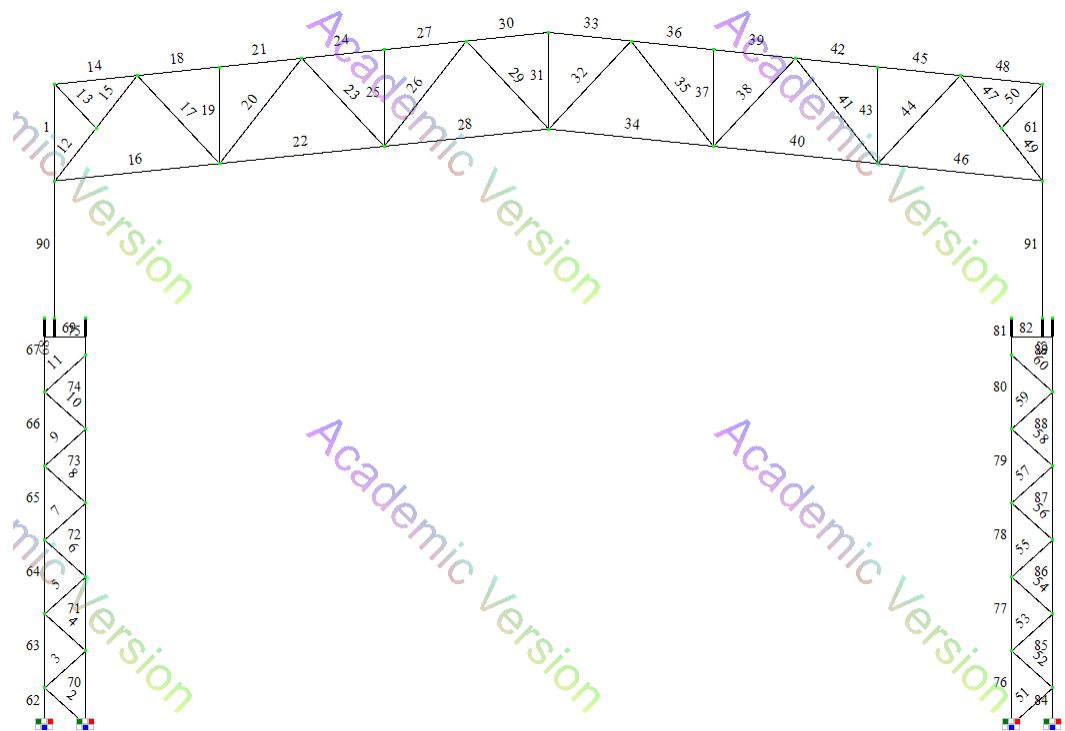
Загальний вигляд рами промислової будівлі з другим варіантом ферми
